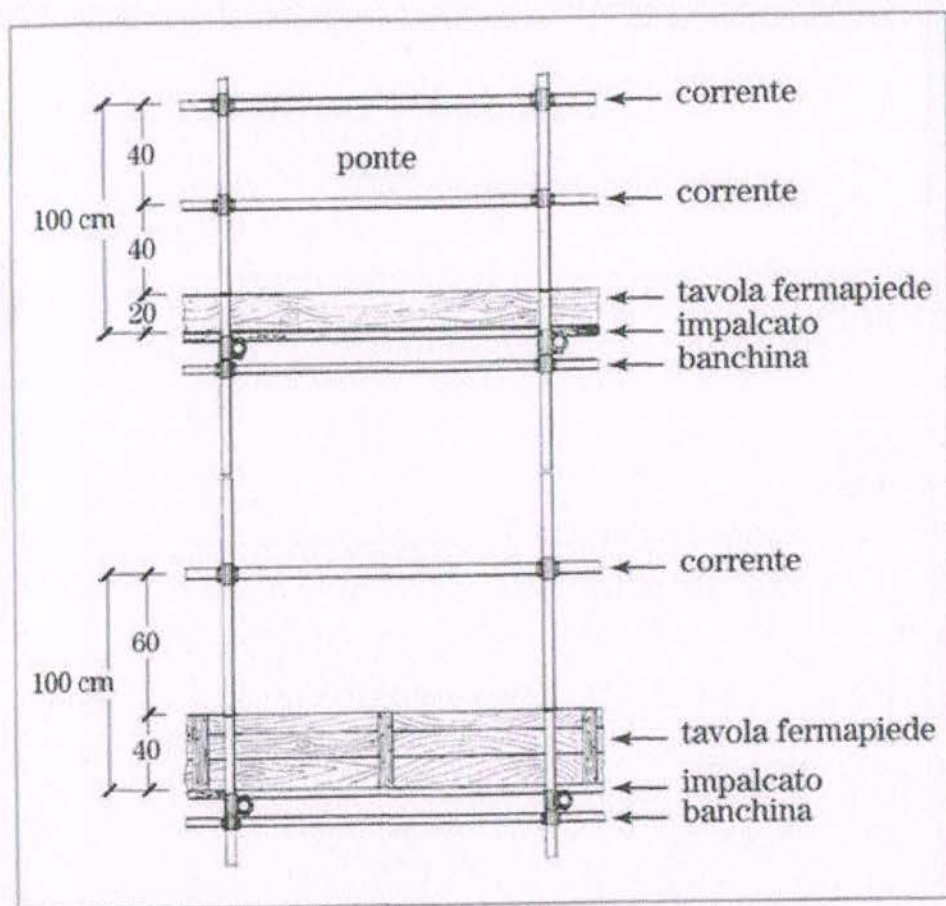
Schema di montaggio delle protezioni in un ponteggio.
